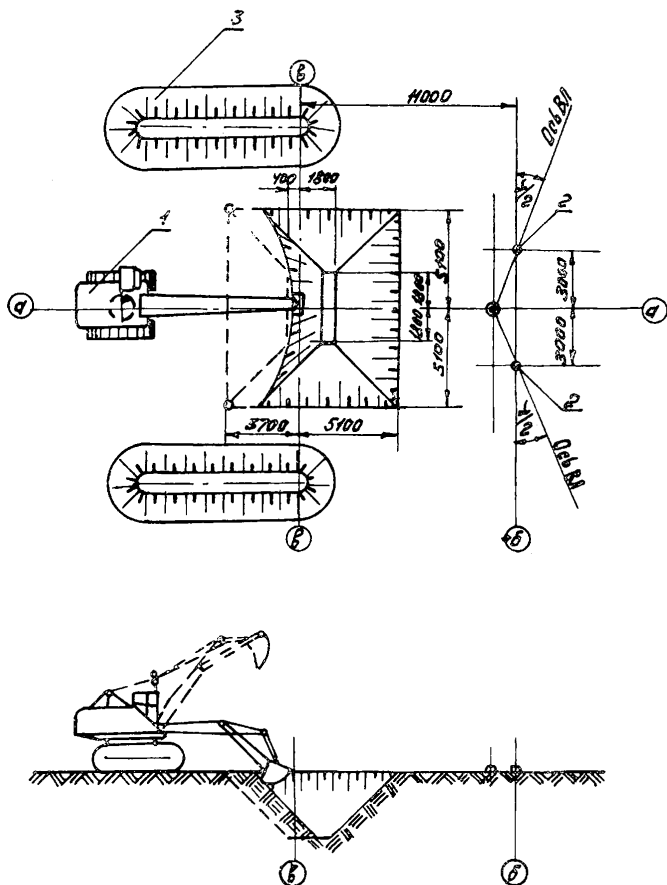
Разработка котлована под анкерные плиты для опор УБНН-3; УБНН-5; УБНН-5; УБНН-7
